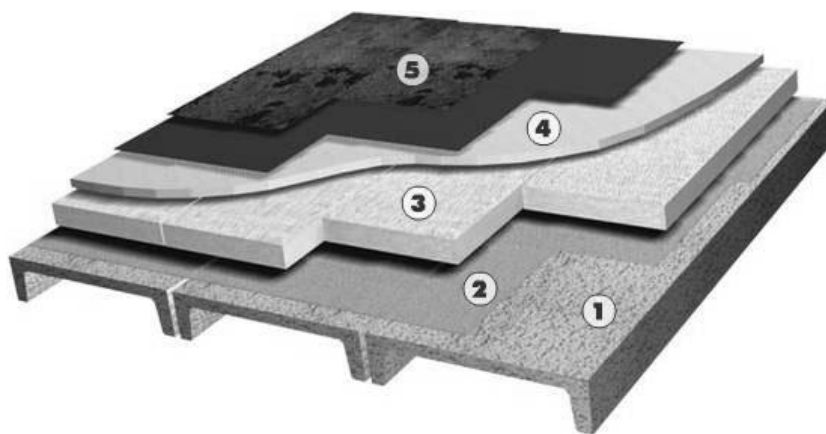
Структура плоской кровли: 1 – плиты покрытия; 2 – слой пароизоляции; 3 – слой утеплителя; 4 – железобетонная стяжка; 5 – слой гидроизоляции (рулонной или наплавляемой)
